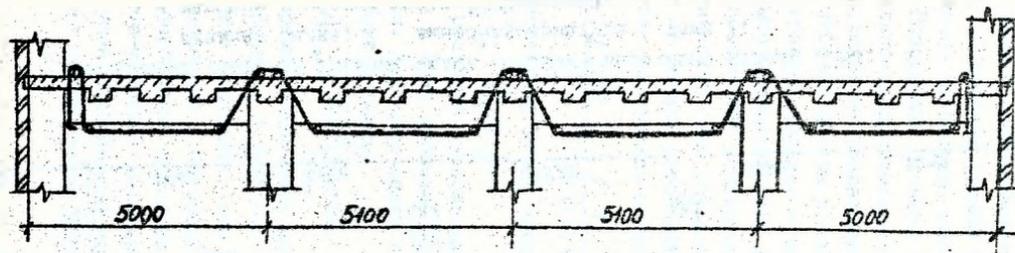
Схема усиления главных балок перекрытия склада готовой продукции НЛБЗ
